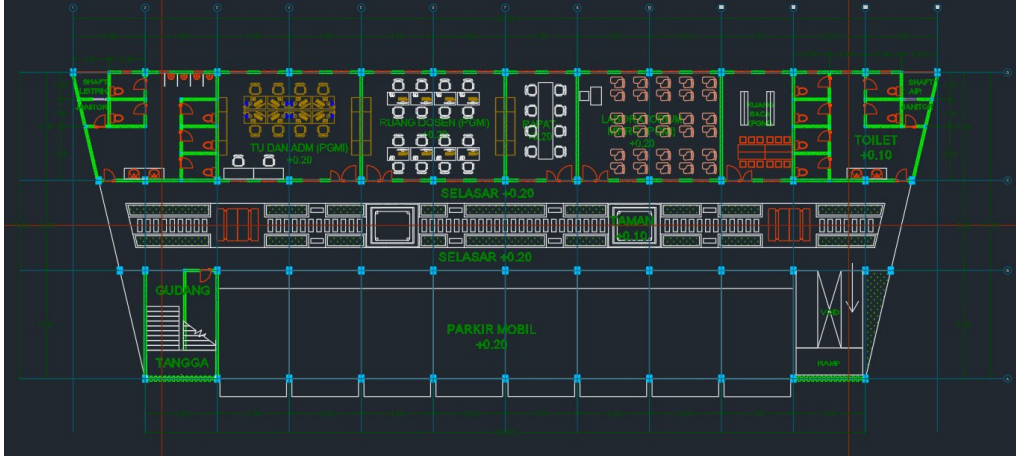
6 perubahan bentuk Blok Plan menjadi Layout Plan.
